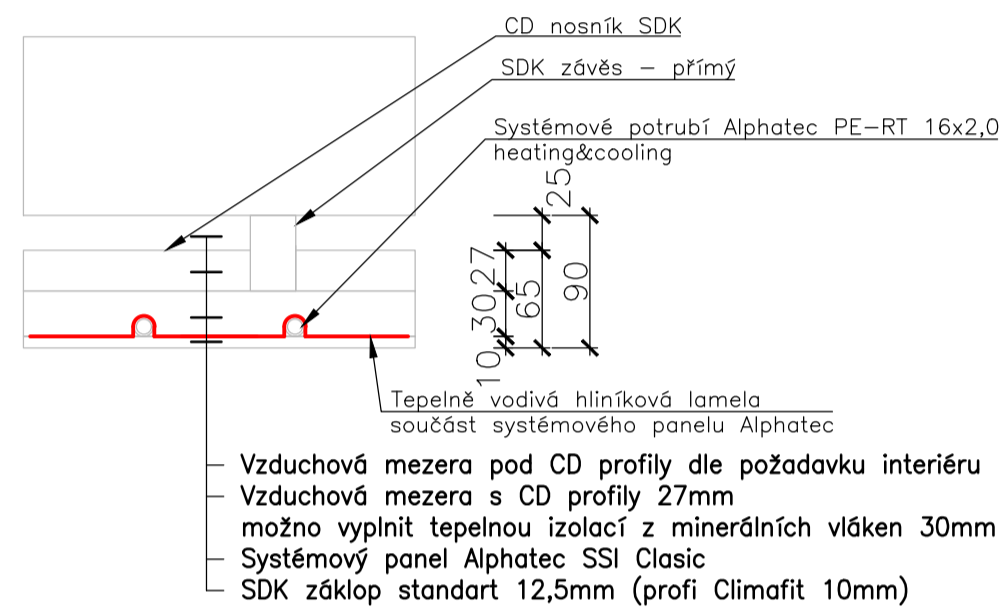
DETAIL SKLADBY STROPNÍ VYTÁPĚNÍ/CHLAZENÍ:
